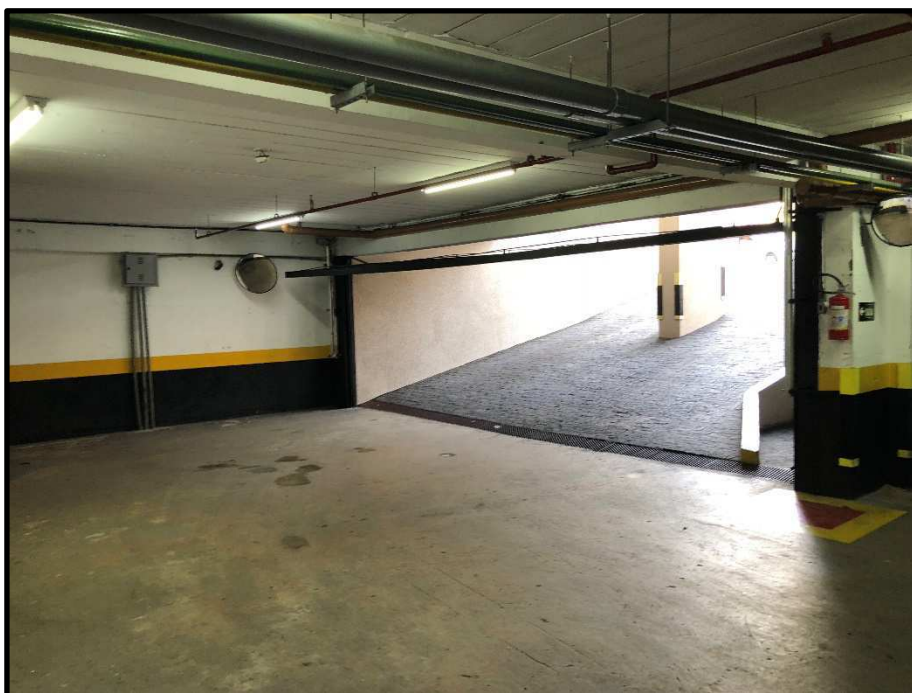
1º subsolo – vagas de garagem – Vista 4
